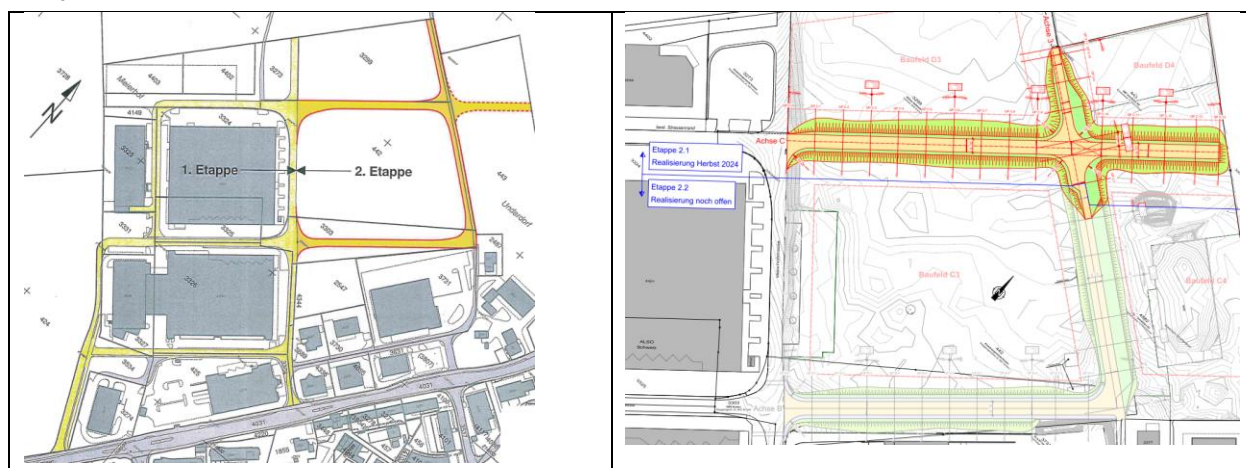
Bild links: Projektperimeter (rot), Etappe 2, Bild rechts: Etappe 2.1
